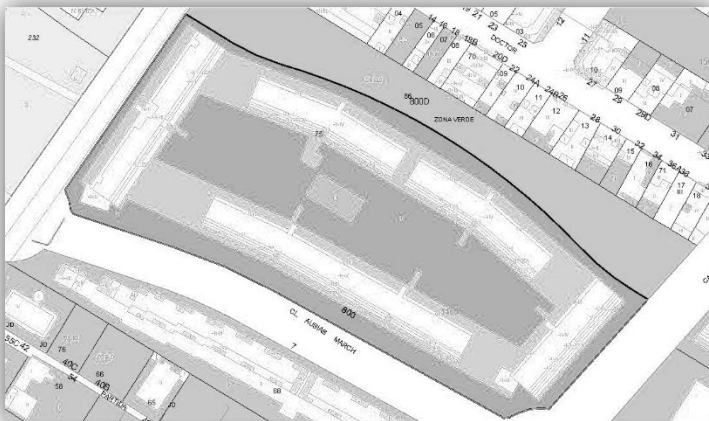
Plano de emplazamiento 2. Fuente Catastro
